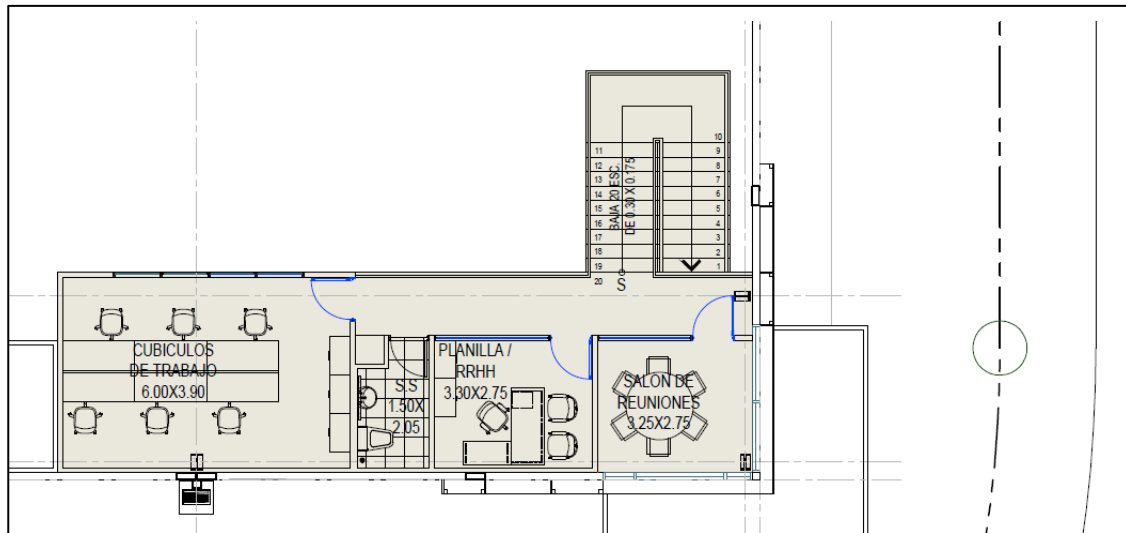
Distribución del mezzanine de la oficina administrativa (planta arquitectónica)
